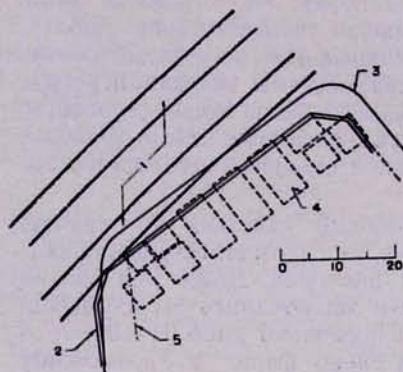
План, показывающий относительное положение фундаментов здания и туннелей метрополитена. 1—туннели; 2—стены подвала; 3—линия бордюра; 4—фундаменты; 5—граница владения.
